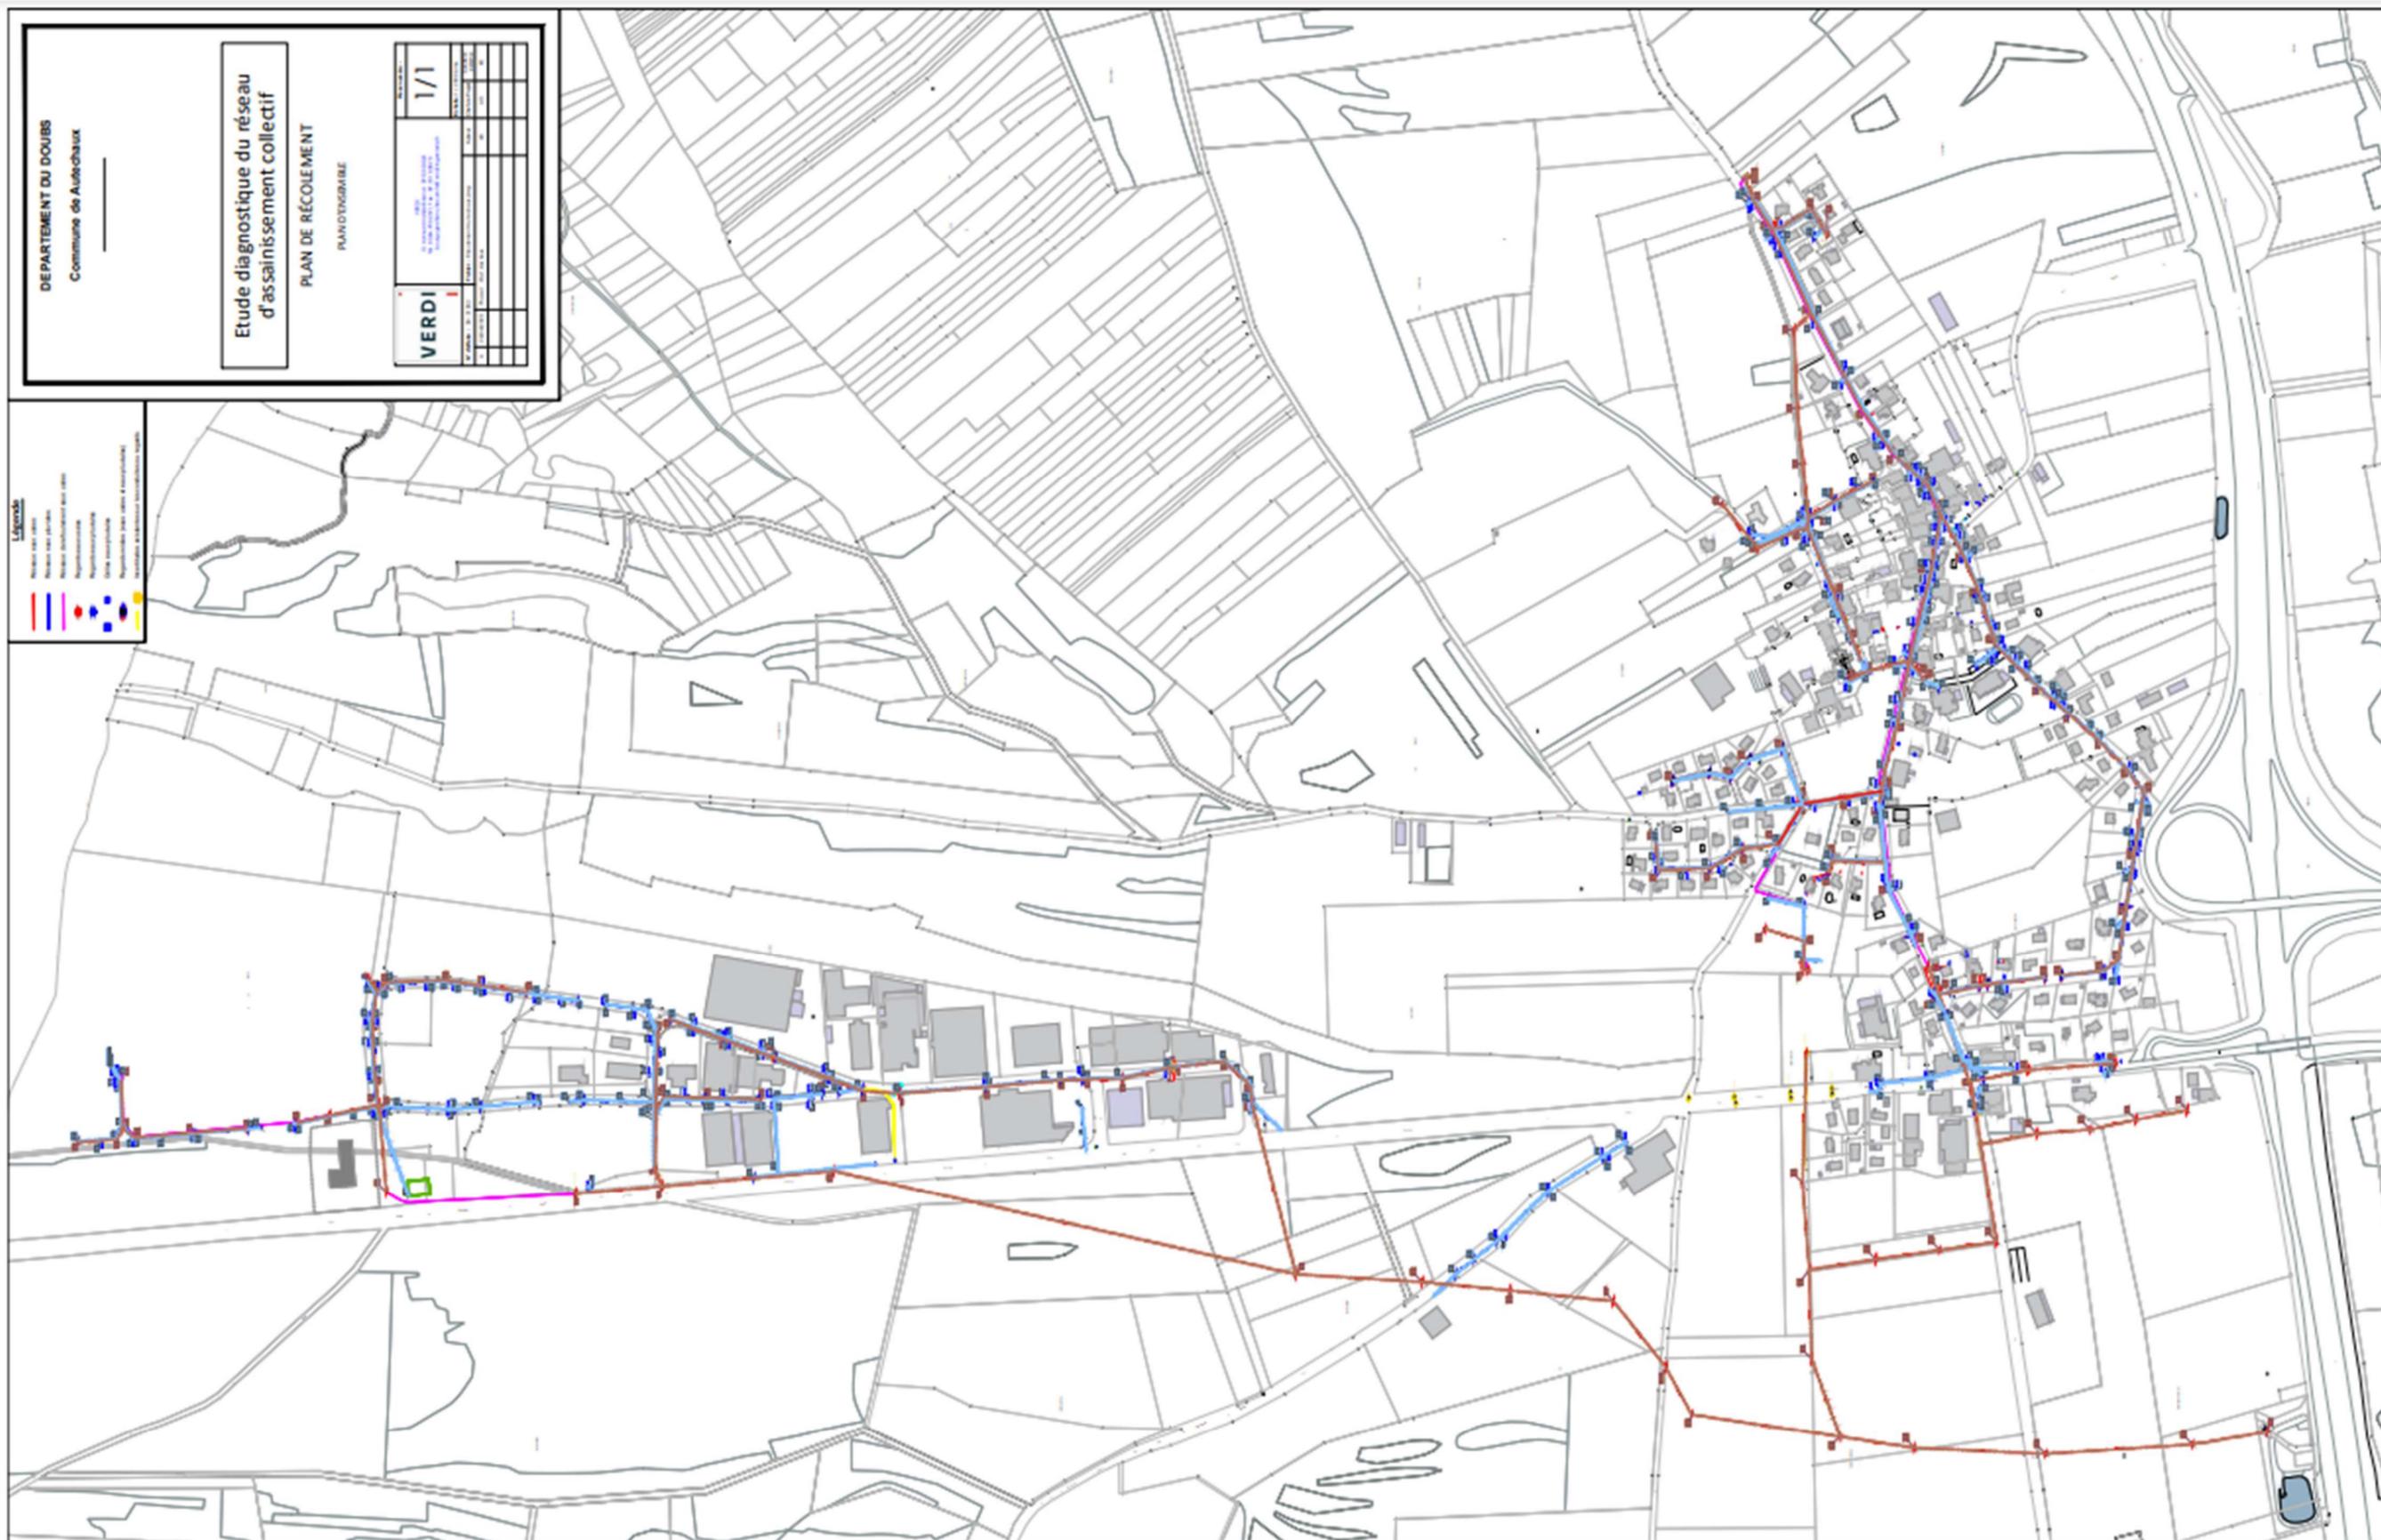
Plan du système de collecte de la commune d'Autechaux
